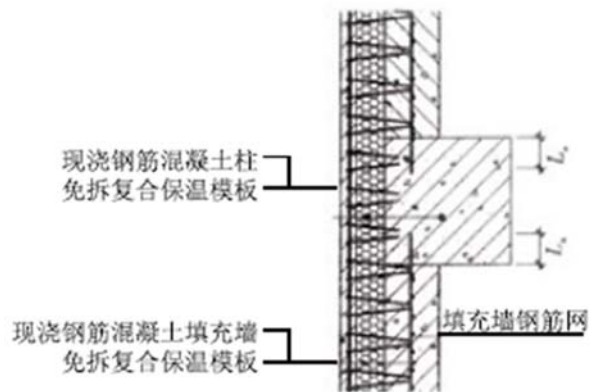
厚防护层免拆复合保温模板与混凝土构件相接部位构造做法
